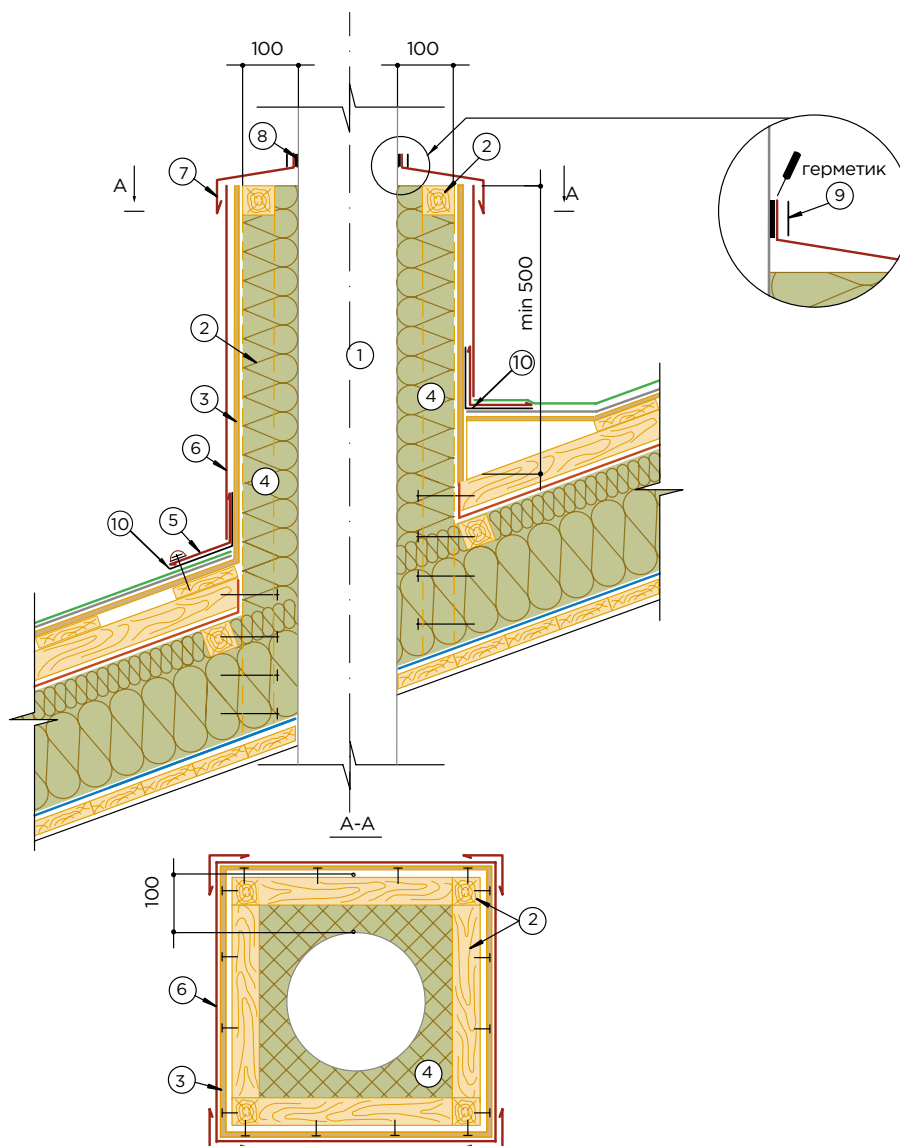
Вариант примыкания кровли мансарды к вентиляционной трубе
